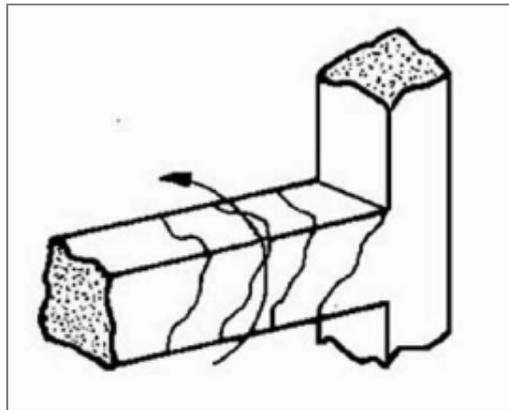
Configuração de fissuras por cisalhamento em vigas
